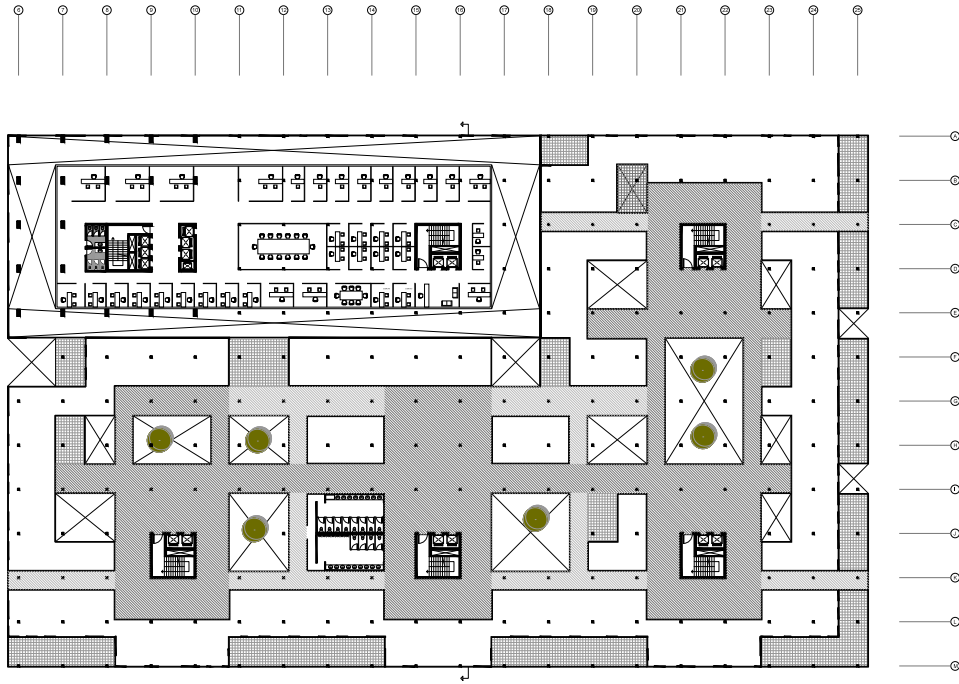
Planta N+/- 7.20 m (elaboración propia)
